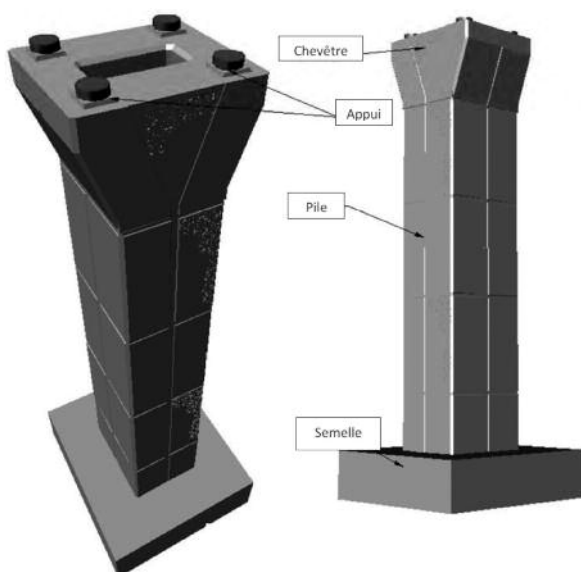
Pile des viaducs à voussoirs préfabriqués / Piers of precast segments viaducts.
